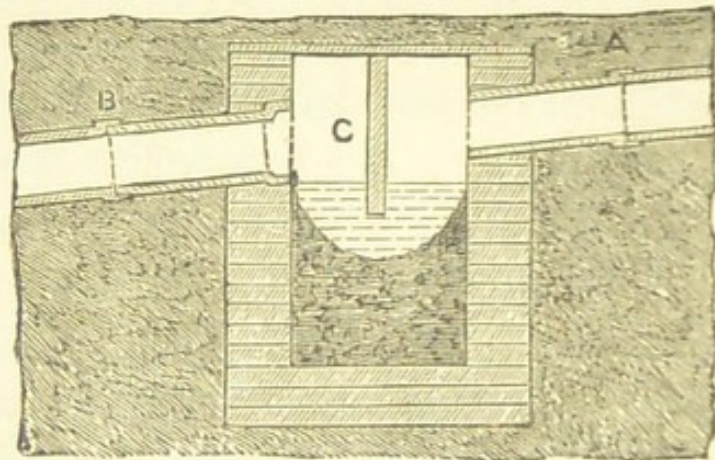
Pierre à immersion : AB conduite; C pierre à immersion.
